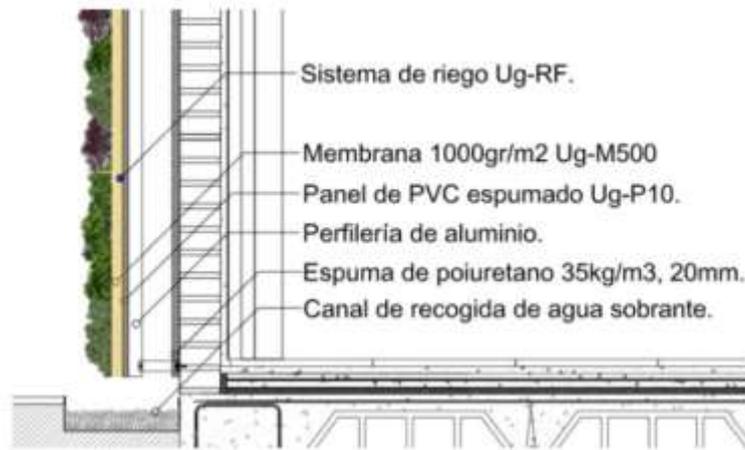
Detalle constructivo de sistema Hidropónico F+P
